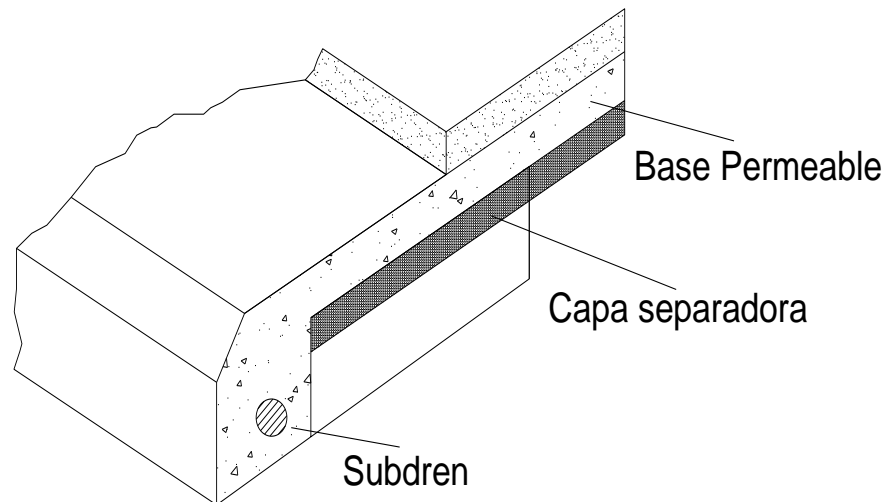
Estructura típica de un pavimento permeable. Adaptado de FHWA (1992).
